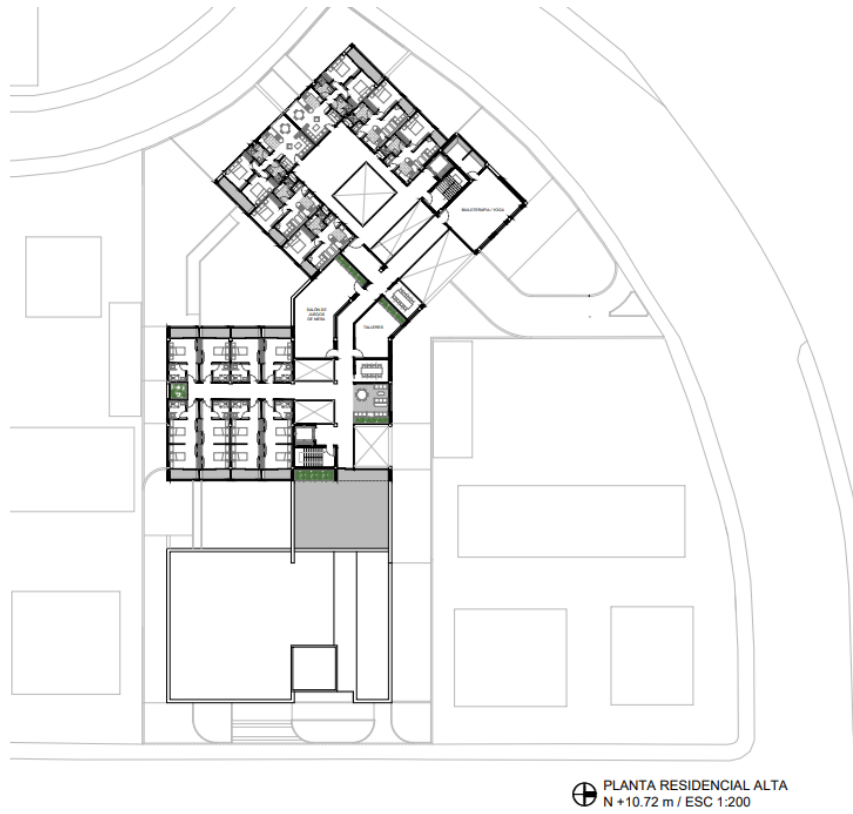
Planimetría: Planta Residencial Alta (N +10.72 m)
